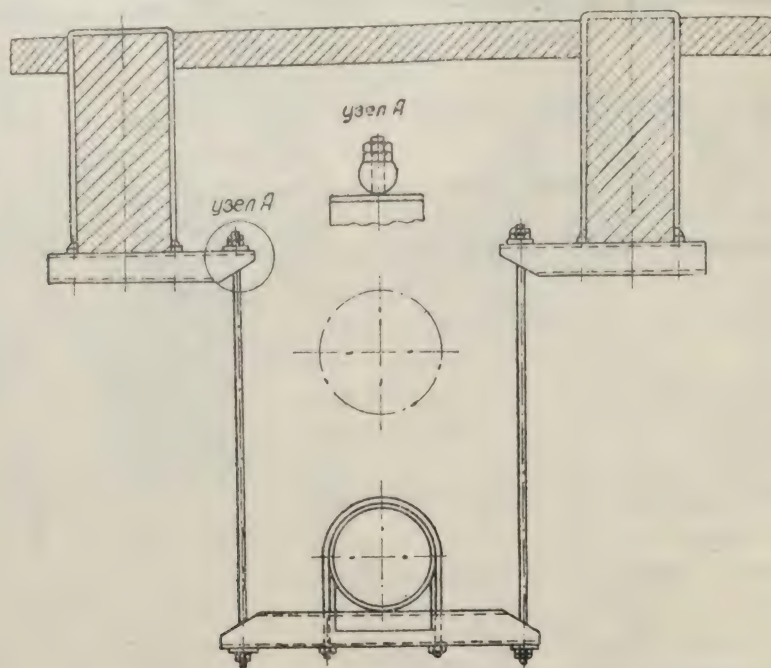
Крепление трубопроводов на опорах из двух тяг.
